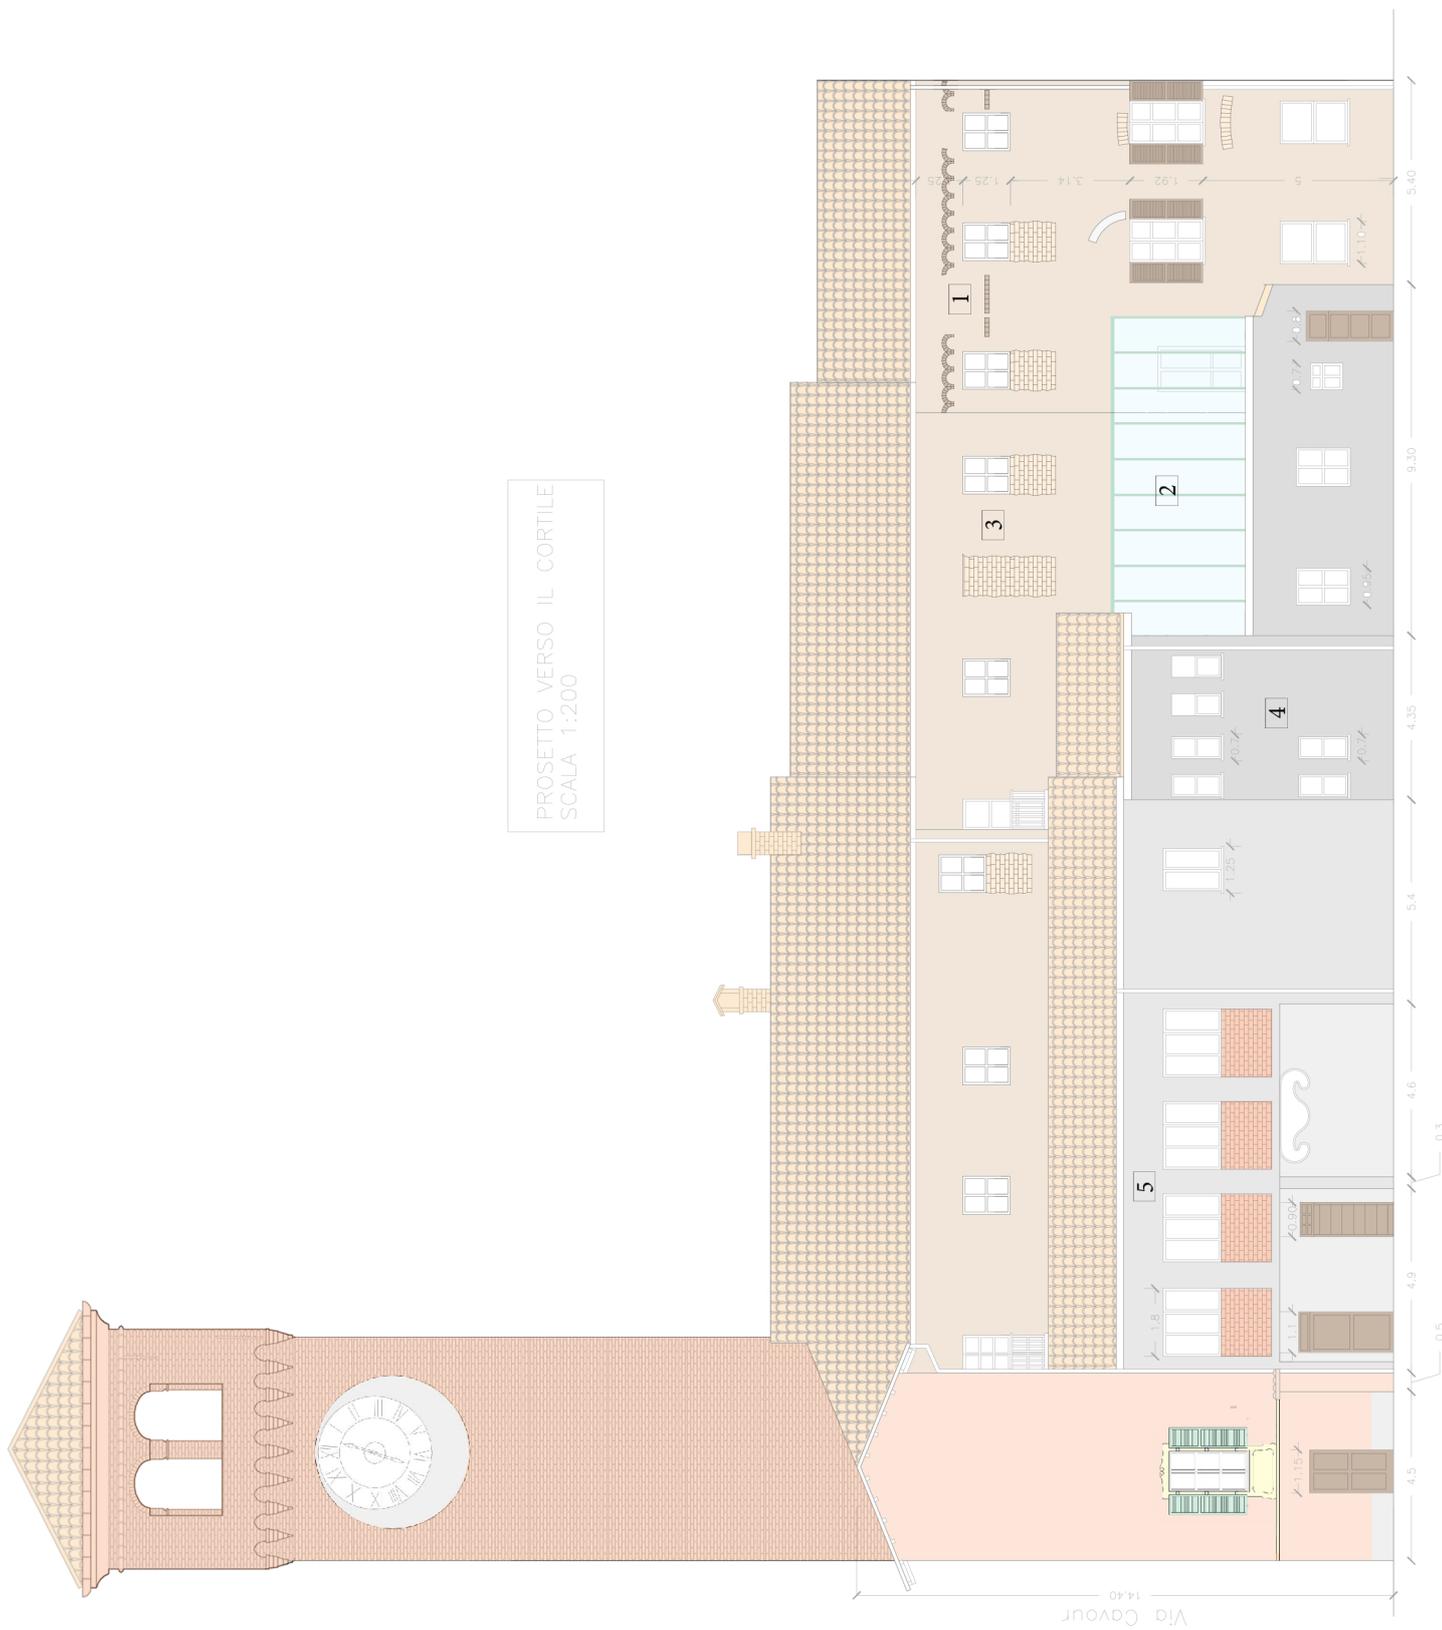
Aperture del piano secondo della zona nord del prospetto est
